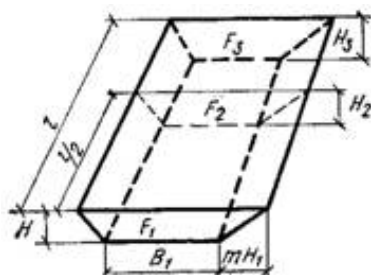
Котлован под здание, имеющий форму усеченной пирамиды
